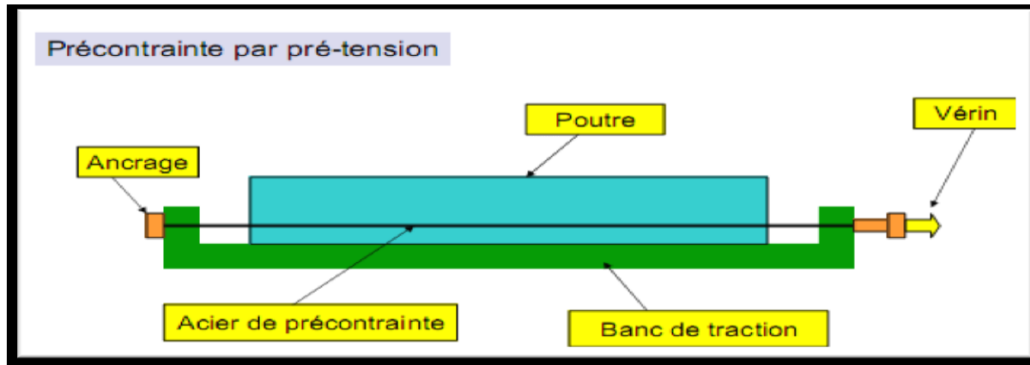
Coupe longitudinale d'une poutre en béton précontraint par pré-tension.
